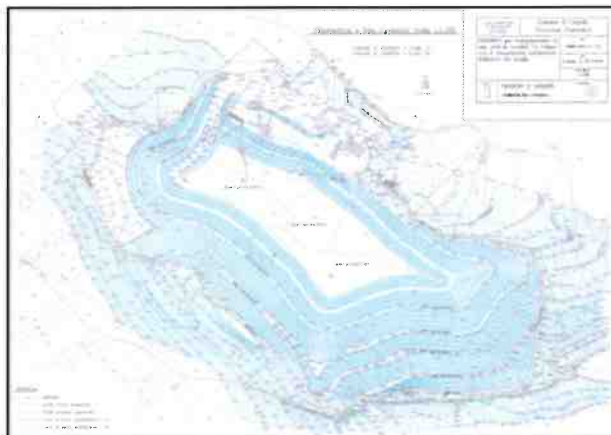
Planimetria Stato fine coltivazione (da elaborato n. 3 allegato allo SPA)
